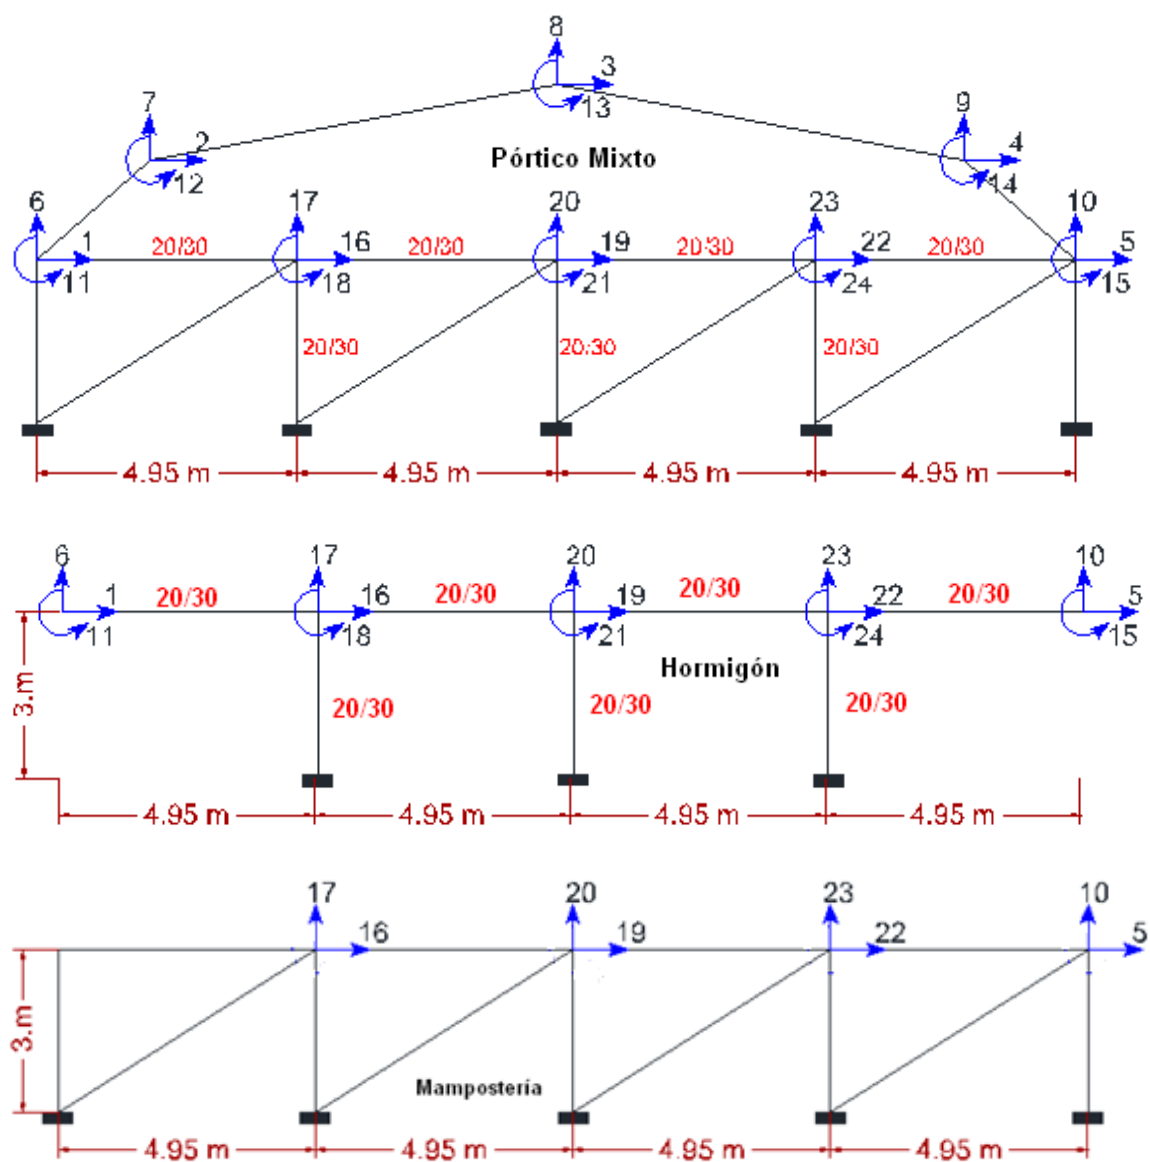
Pórtico transversal exterior de la Fachada que da a estructuras con Paraboloides.
